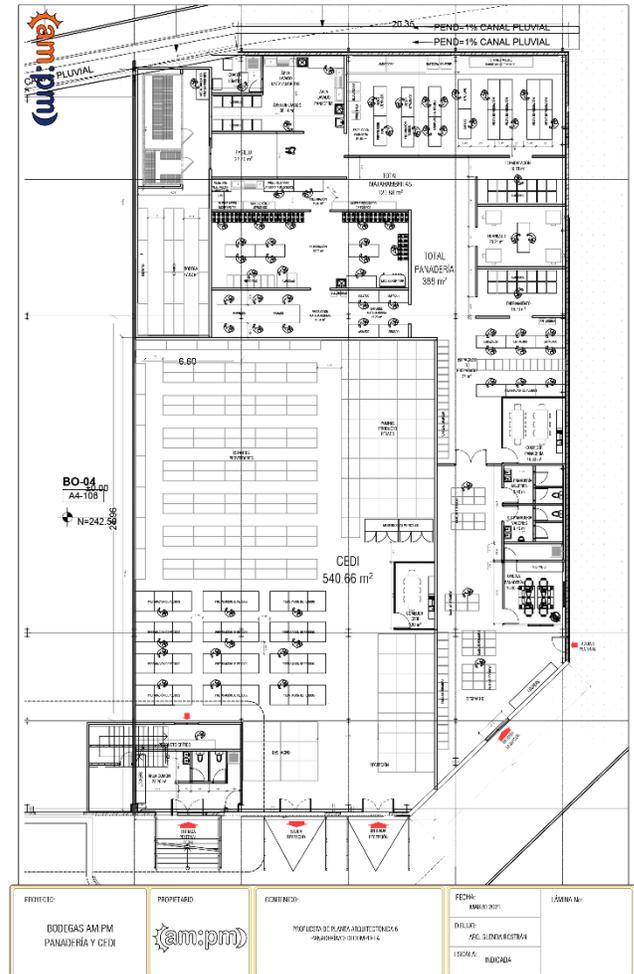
Planos de Propuestas de Planta arquitectónica para Centro de Producción AMPM en Bodegas de Celoxsa
